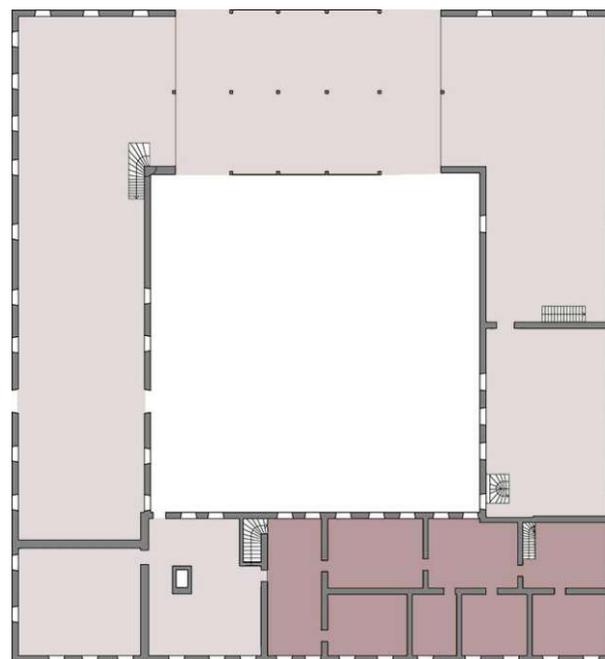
| Vierkanthof Grundriss Obergeschoss
